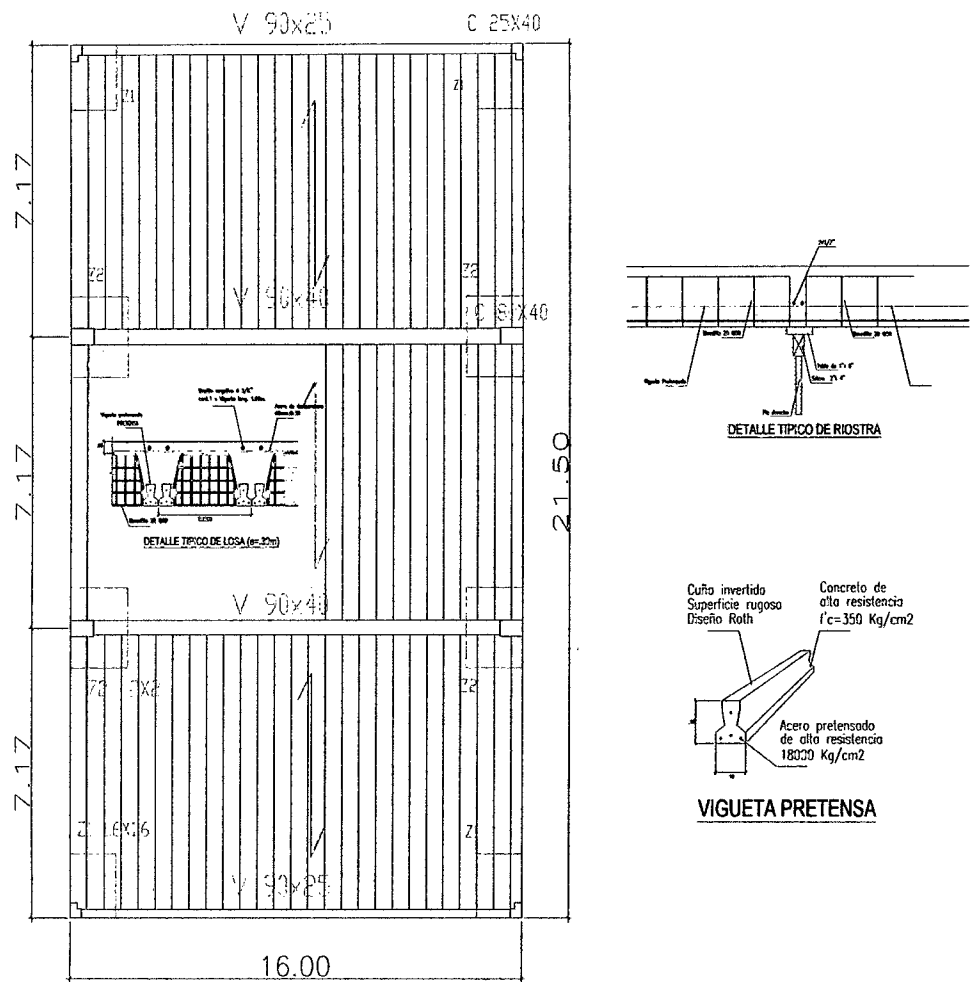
Pórtico estructurado con viguetas Pretensadas y poliestireno
